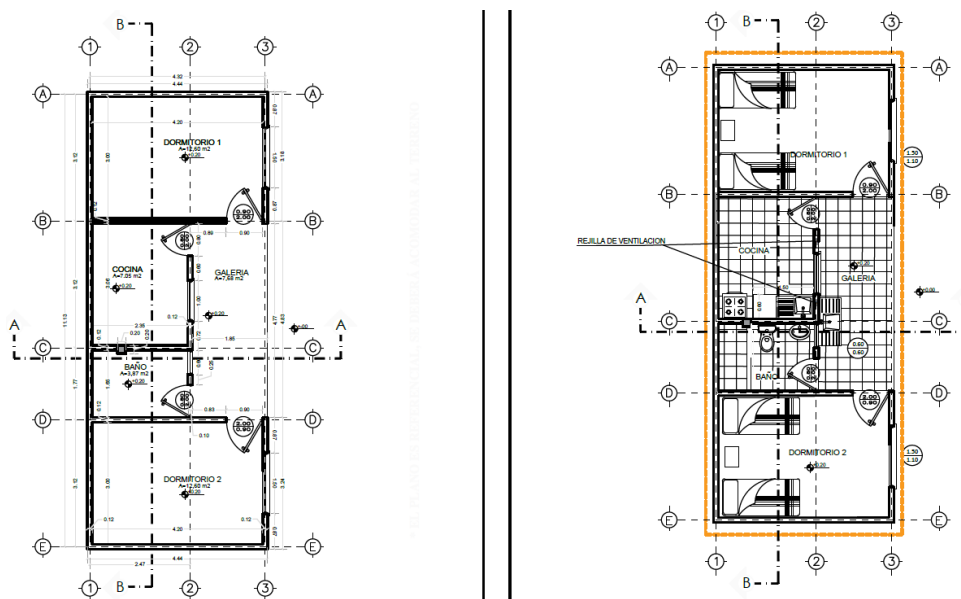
Planos Arquitectónico, Planta acotada y planta amoblada
